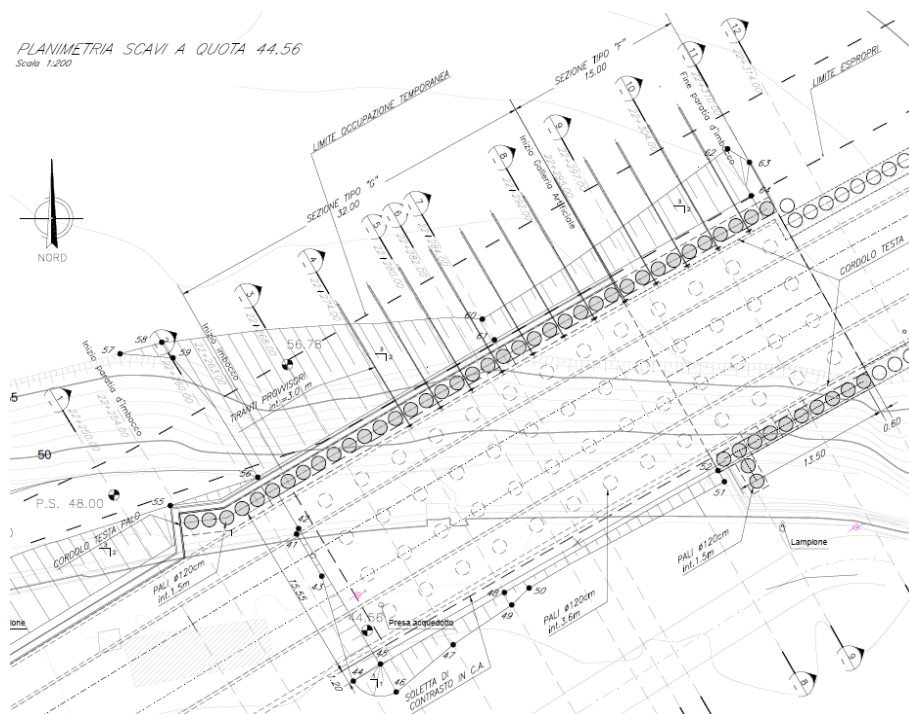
Pianta dell'imbocco lato Canello, pianta scavi a fondo scavo
